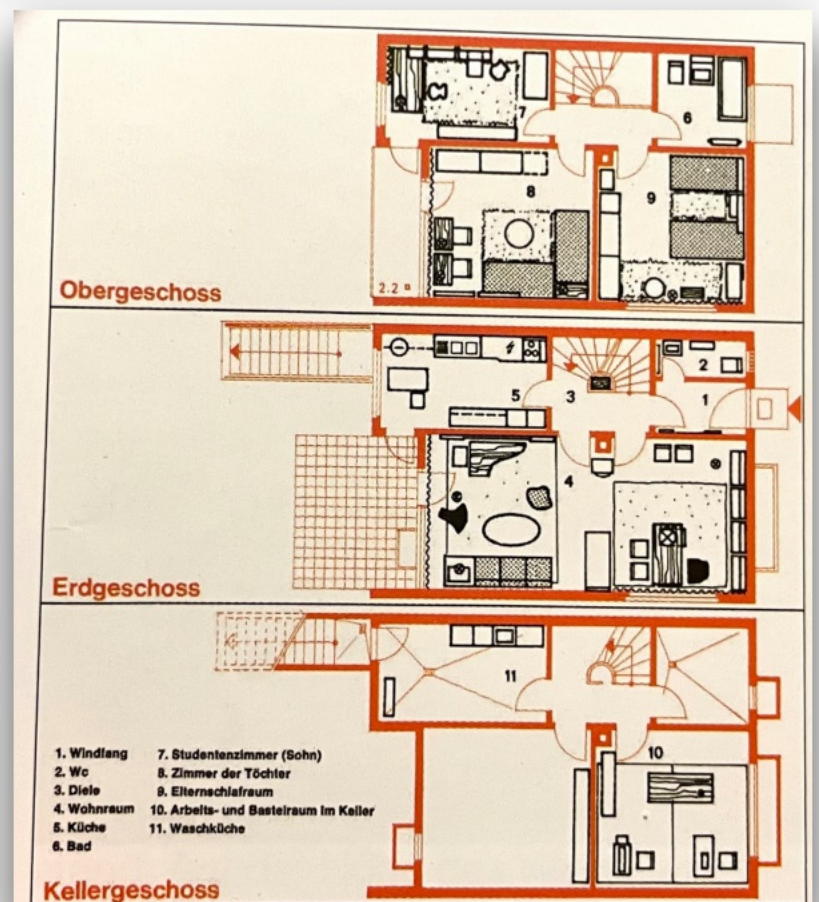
Grundrisse Reihenhäuser mit Möblierung
